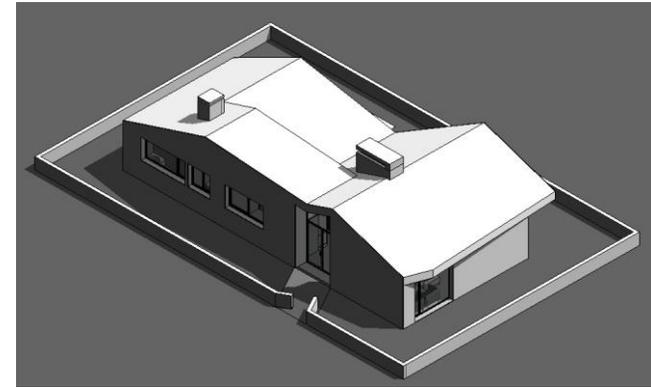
Unión en muro y cubierta mejorados. Fuente: Elaboración propia.
